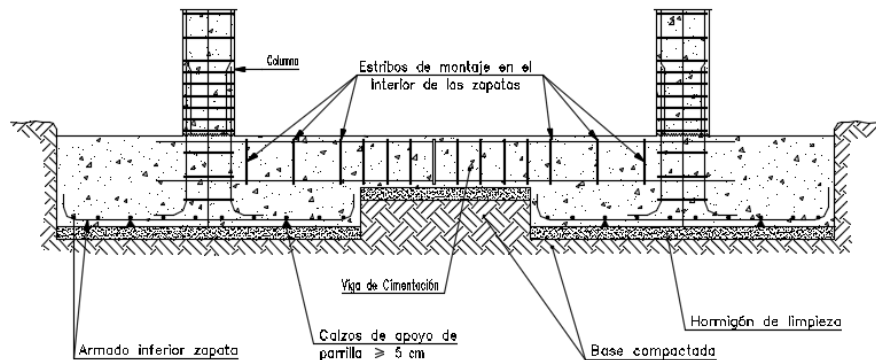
Detalle conexión vigas de cimentación con las zapatas existentes.
